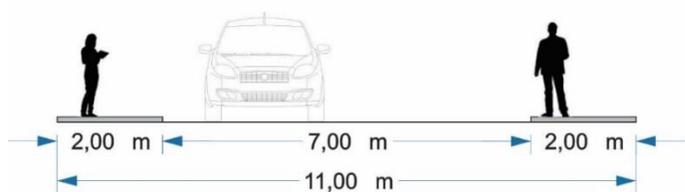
Levantamiento perfiles vialesFuente: (Elaboración propia, 2020)
